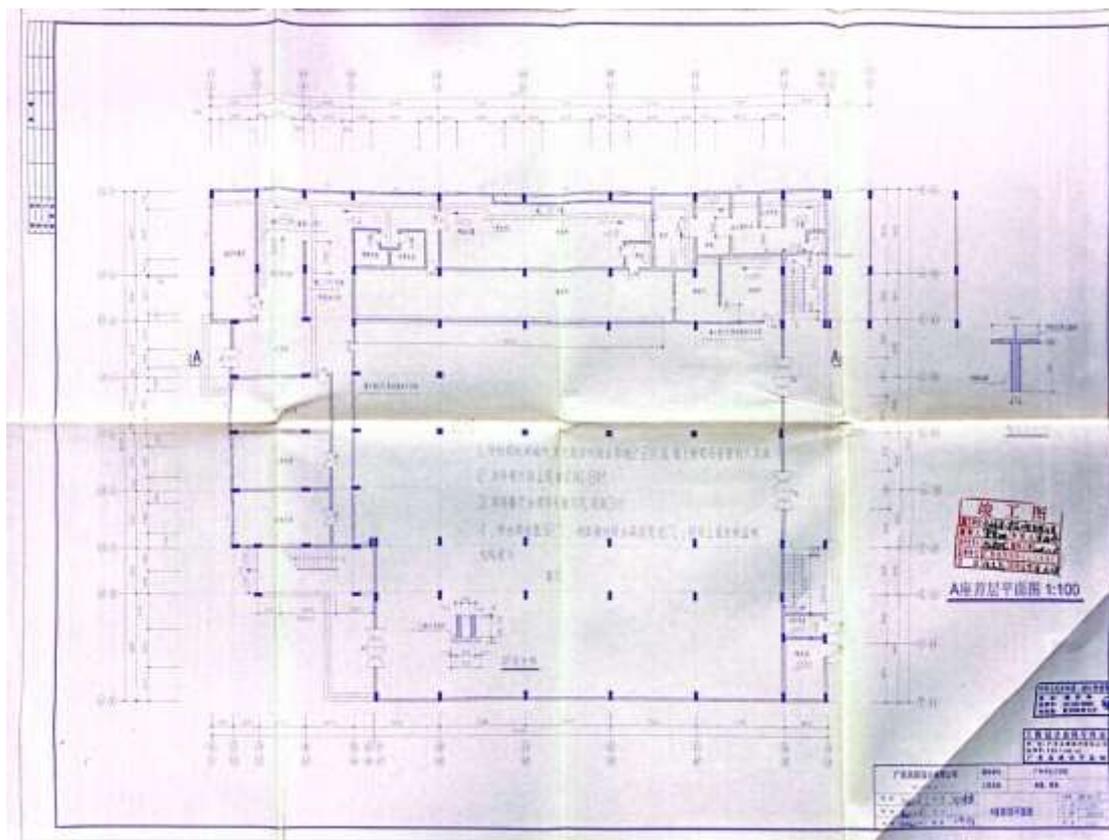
A 食堂（A 栋宿舍楼首层）平面图
